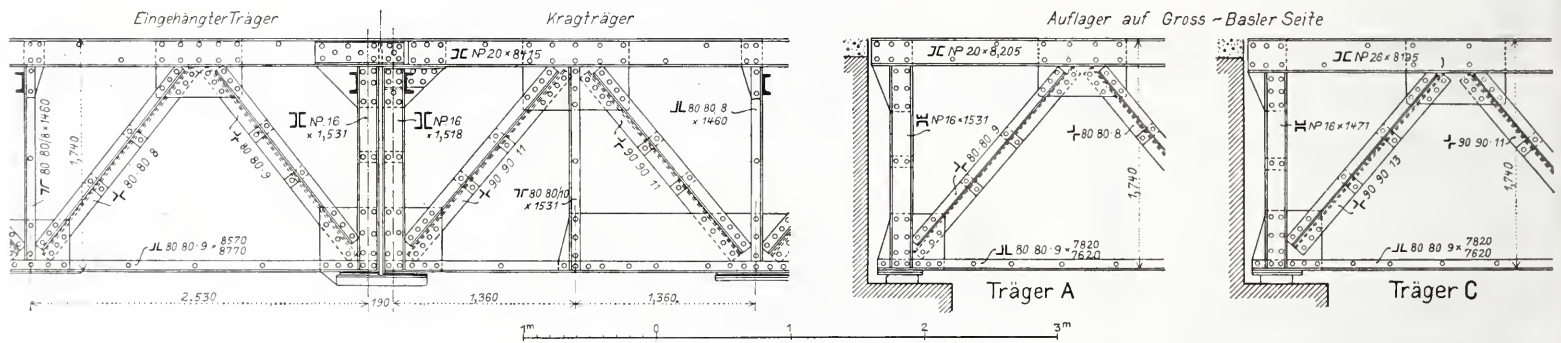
Details der Parallelträger. — Masstab 1:60.
